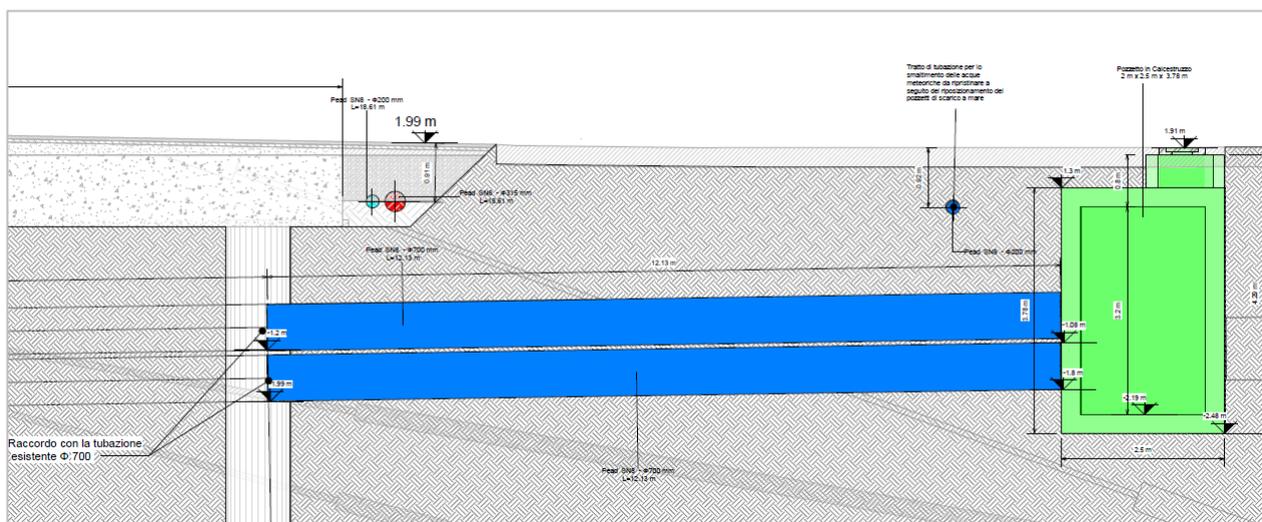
Vista in sezione dei nuovi pozzetti d'ispezione e dei nuovi tratti di scarico a mare
